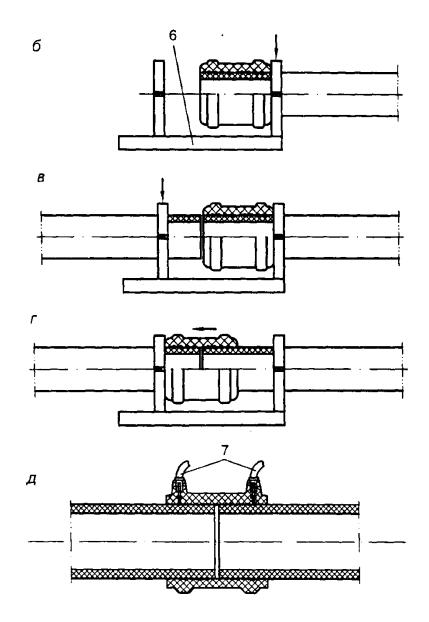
Технологический процесс соединения труб с помощью соединительных деталей с закладными нагревателями
